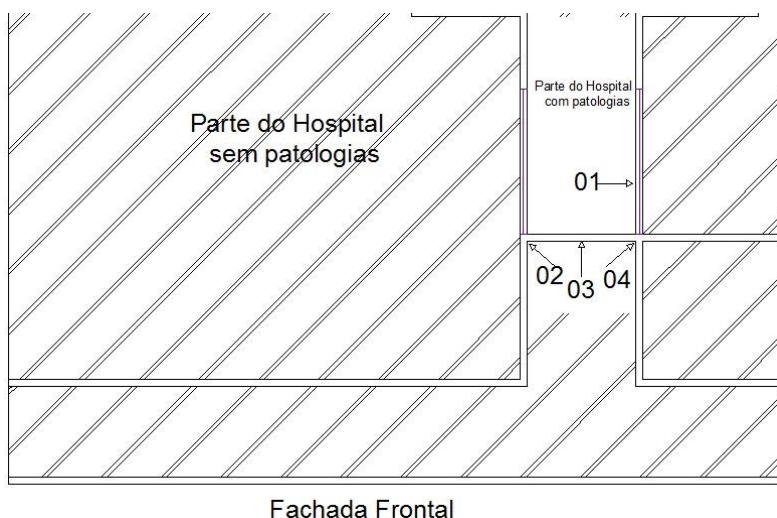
Croqui da localização das fissuras na Associação Hospitalar
